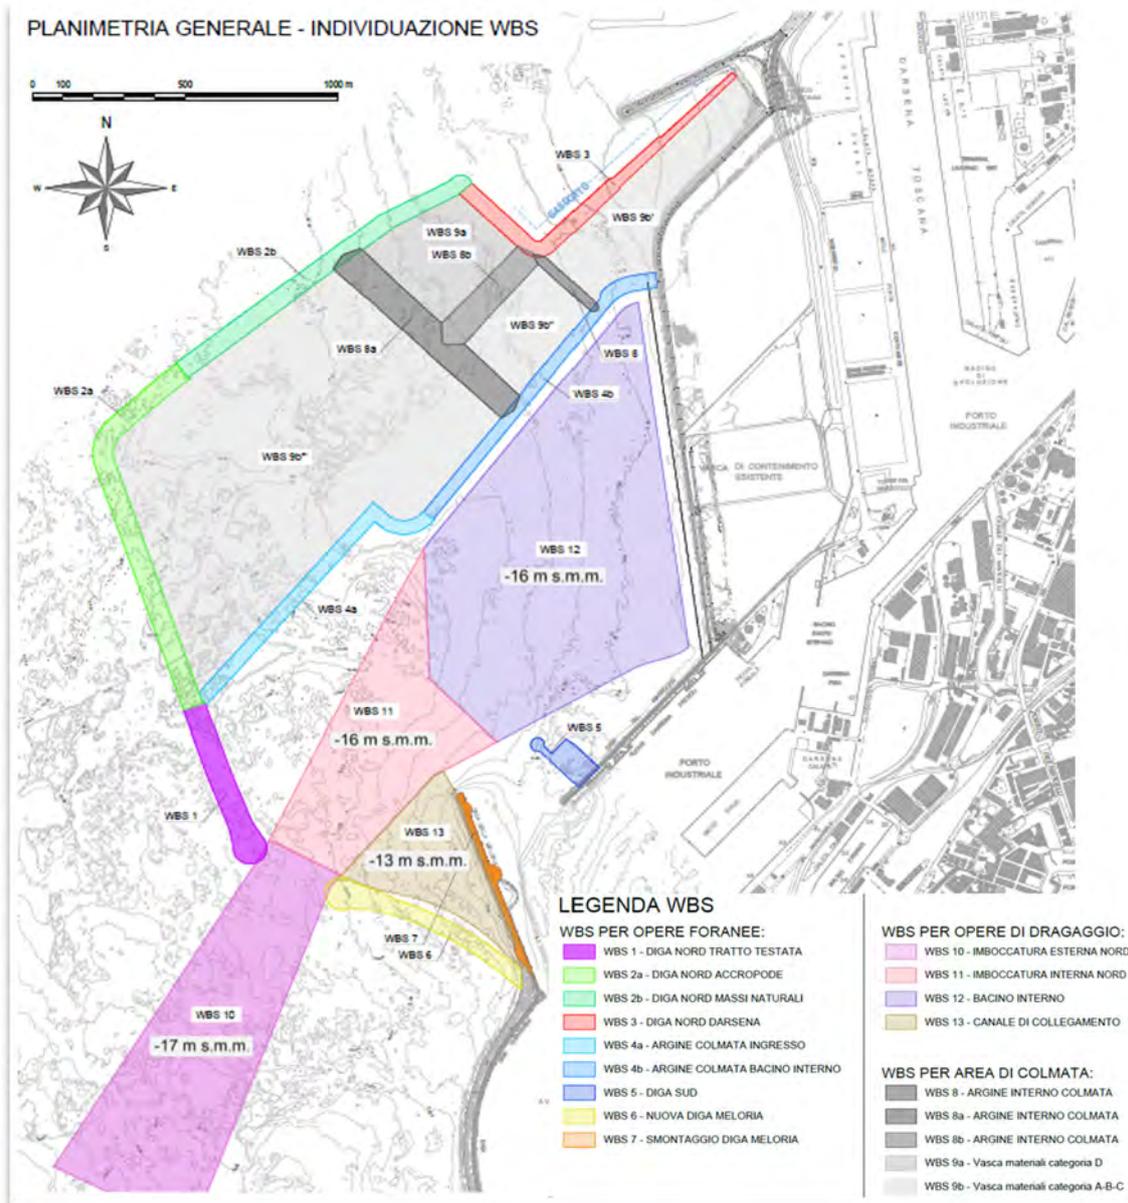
Planimetria di progetto con rappresentazione dei corpi d'opera principali (WBS)
